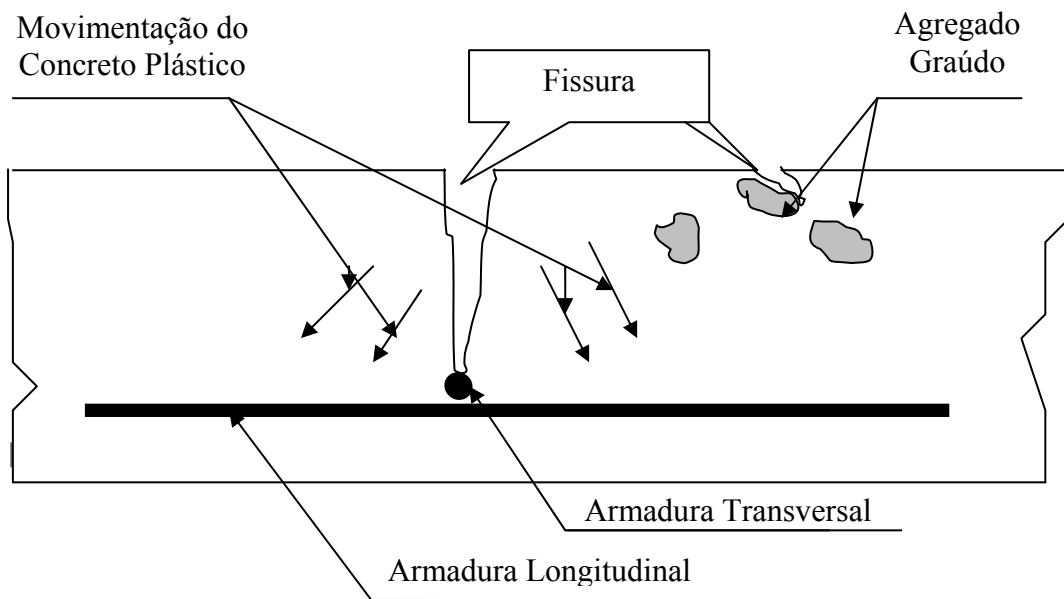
Fissura pós assentamento plástico no concreto devido à restrição da armadura e do agregado graúdo. Adaptado de Padaratz (2005).
